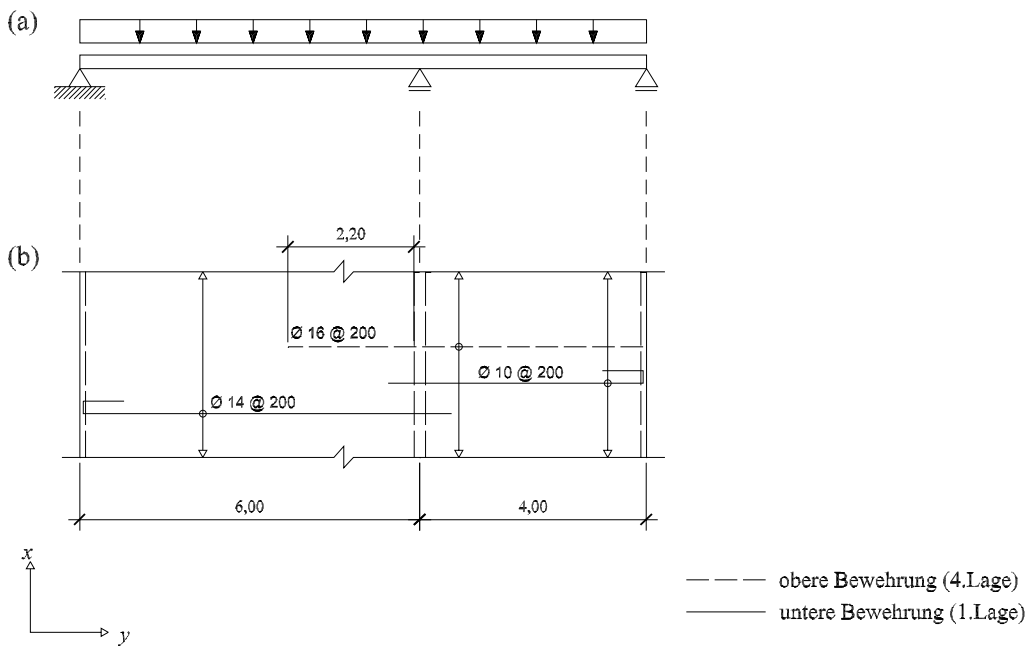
Grundriss und Lagerung der in Aufgabe 1 betrachteten Platte. Abmessungen in m.
